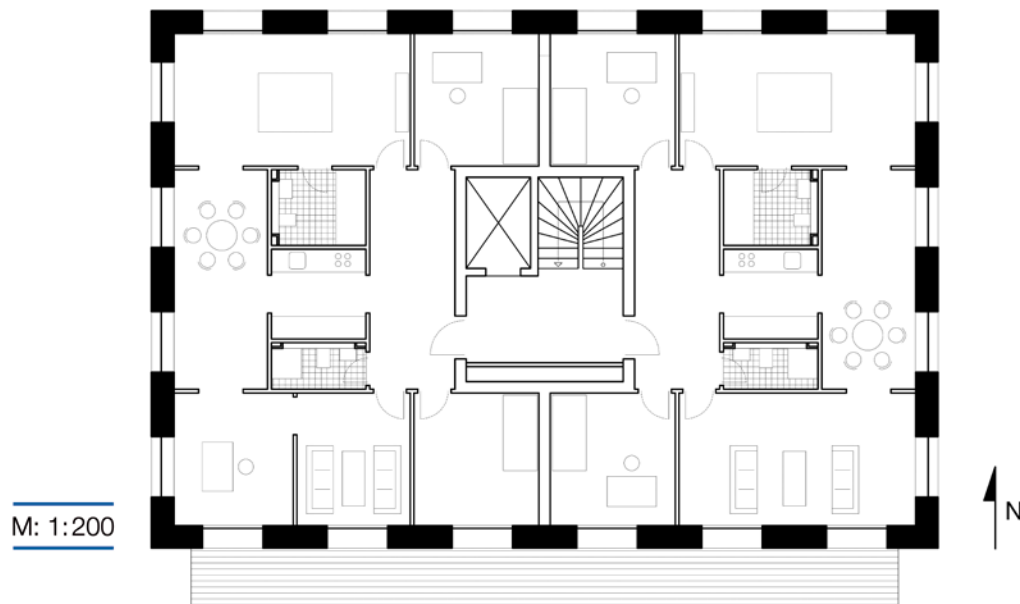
Typenentwurf »freistehendes Wohngebäude«, Grundriss Regelgeschoss
